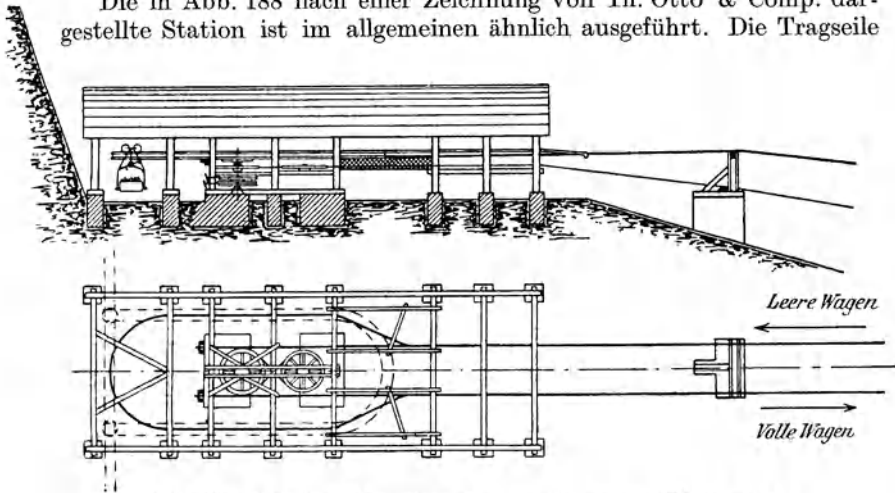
Beladestation einer Bremsseilbahn mit Unterwagen.
